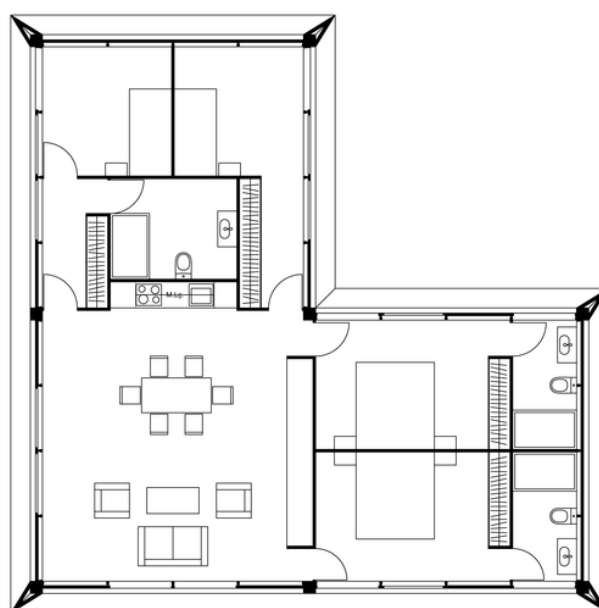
Planta de tipologia MIMA *House 3.0* T4 com 167 m².
